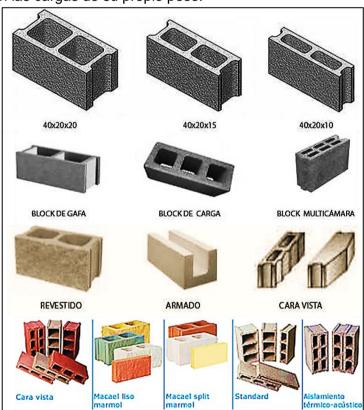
Tipos de bloques de hormigón. (Bloques de Concreto: Historia y Diseño de los bloques de concreto, 2019)
